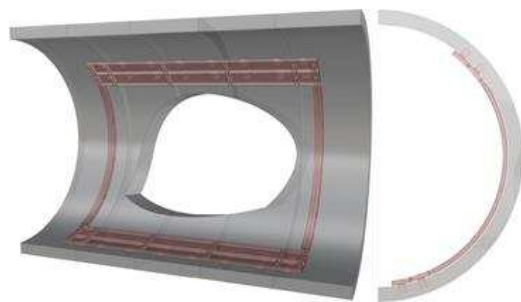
Structure provisoire de reprise au droit des intersections tunnel – rameaux.
